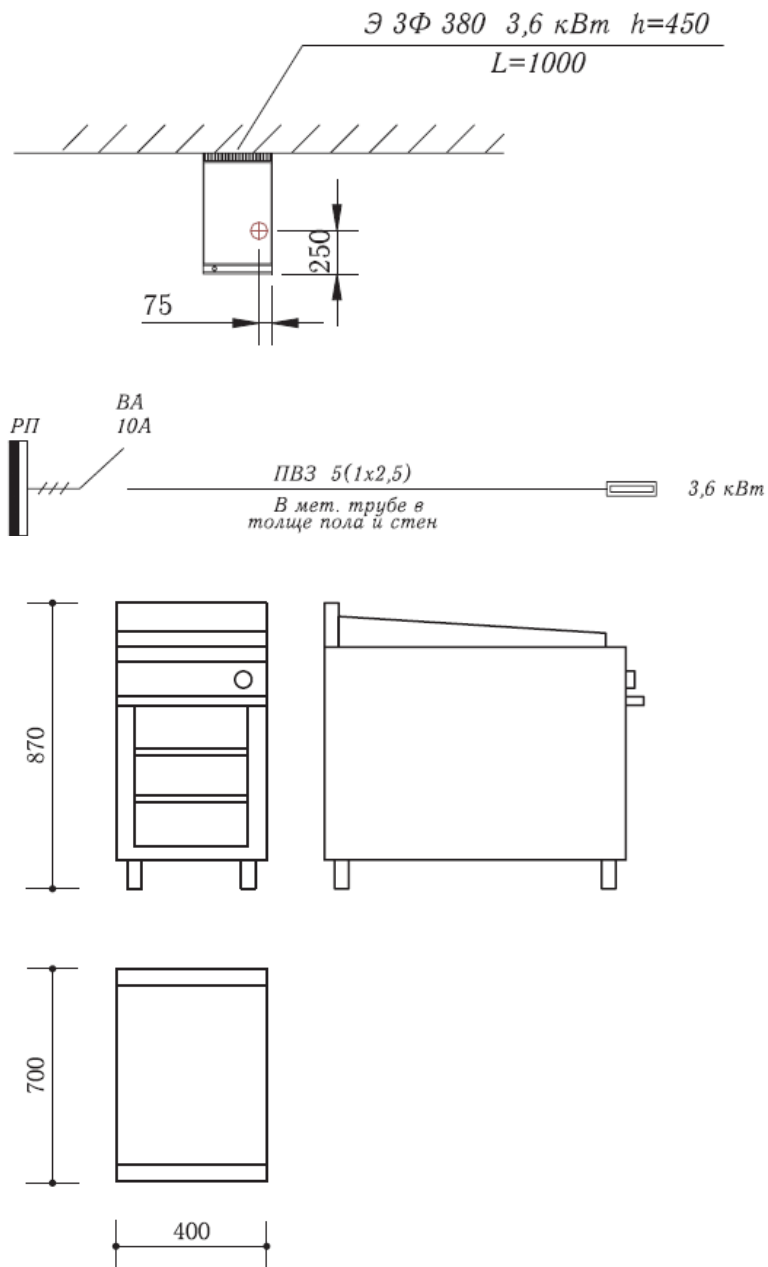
Схема подключения и габаритные размеры открытой сковороды RADA ПЖЭ-700
